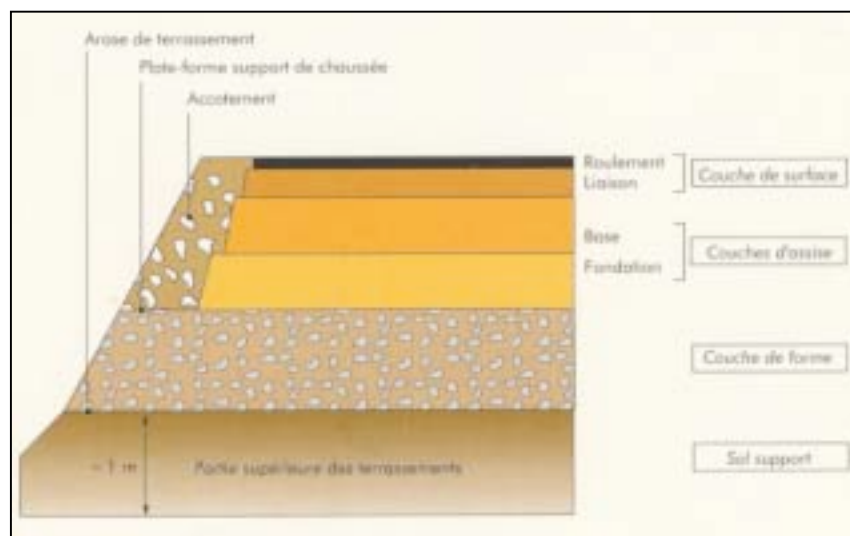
Coupe verticale d'un corps de chaussée [SET 94].
